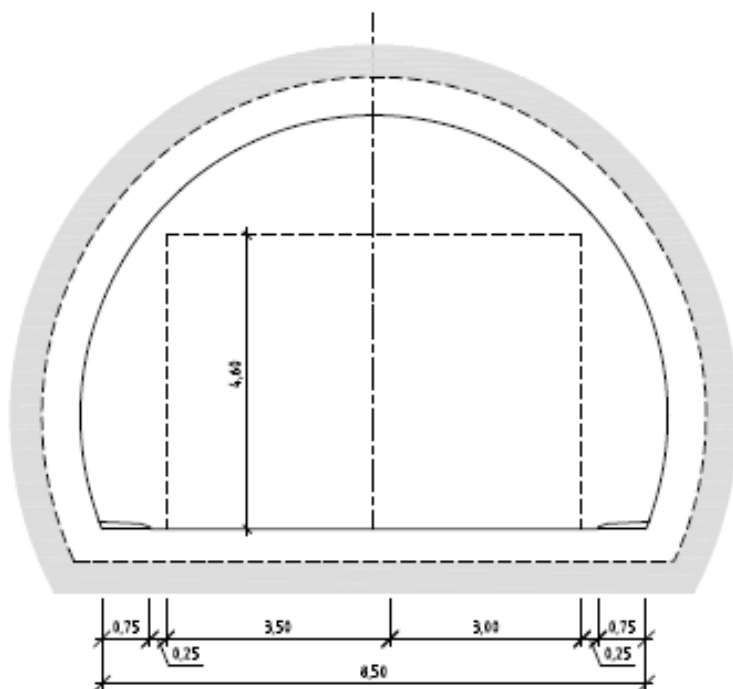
Tunnelprofil T7,5 (mål i m)
